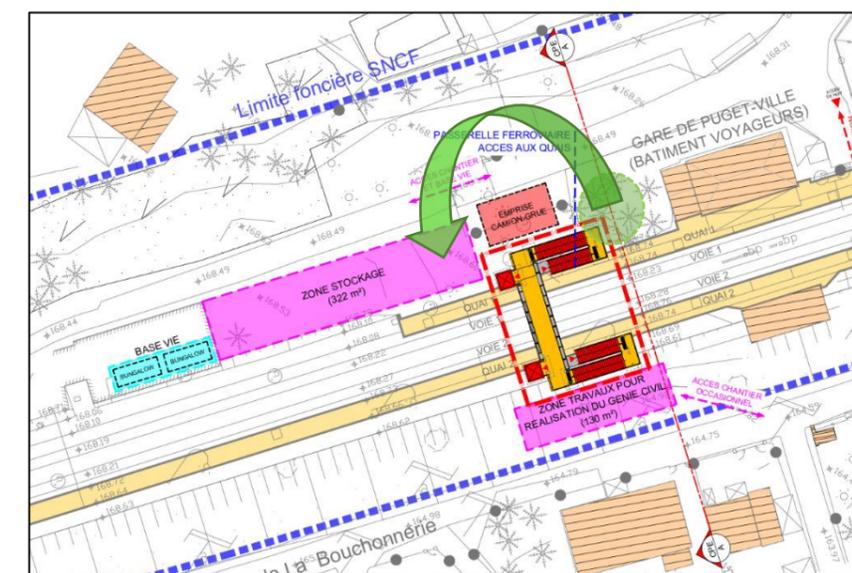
Puget - Ville - Plan d'installation de chantier (AREP, 2021)
